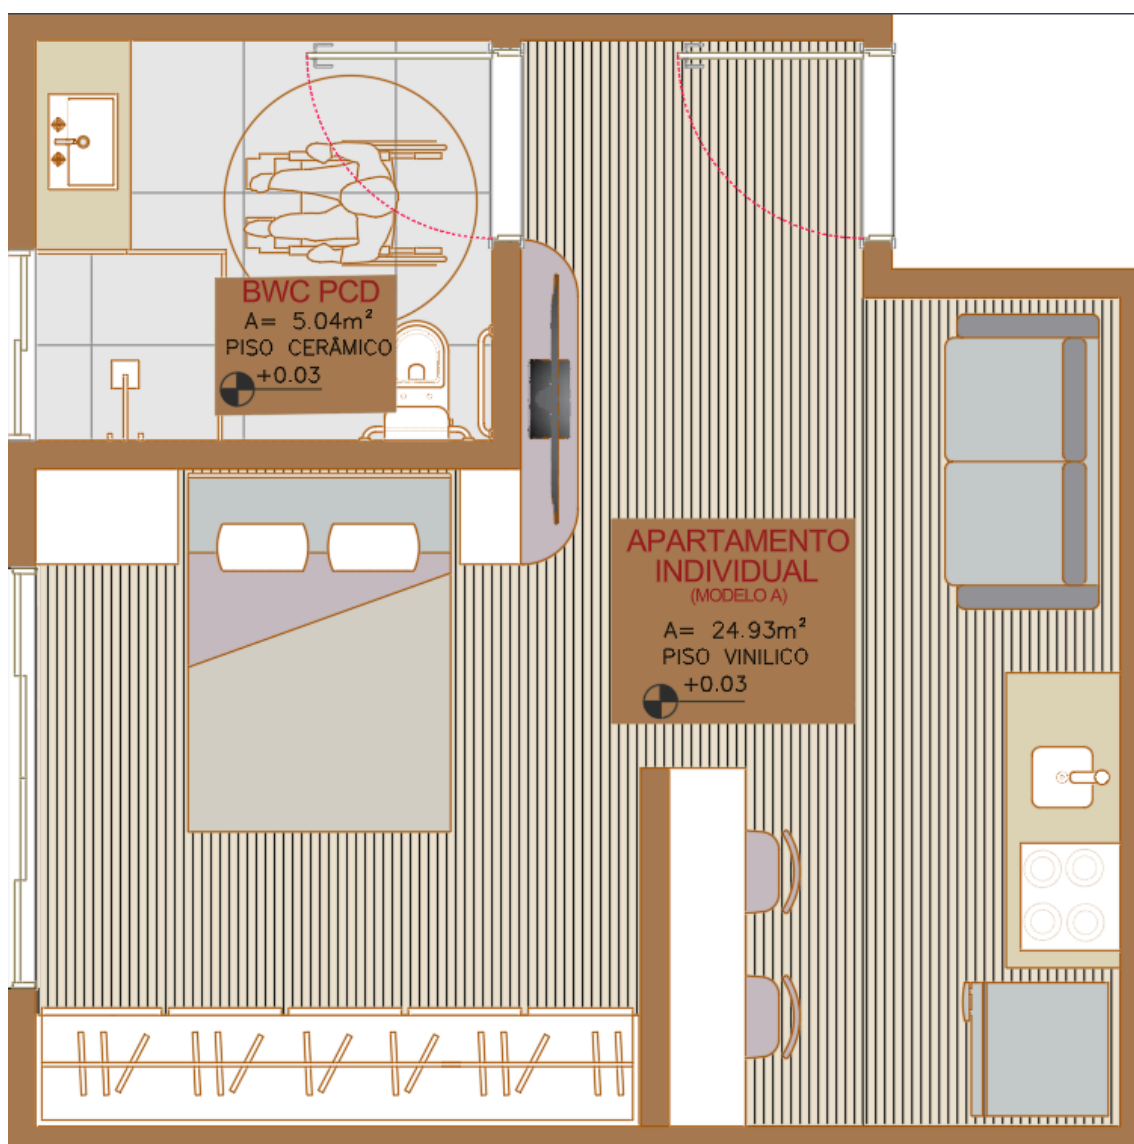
Imagem Planta de Layout do Apartamento Individual Modelo A.
